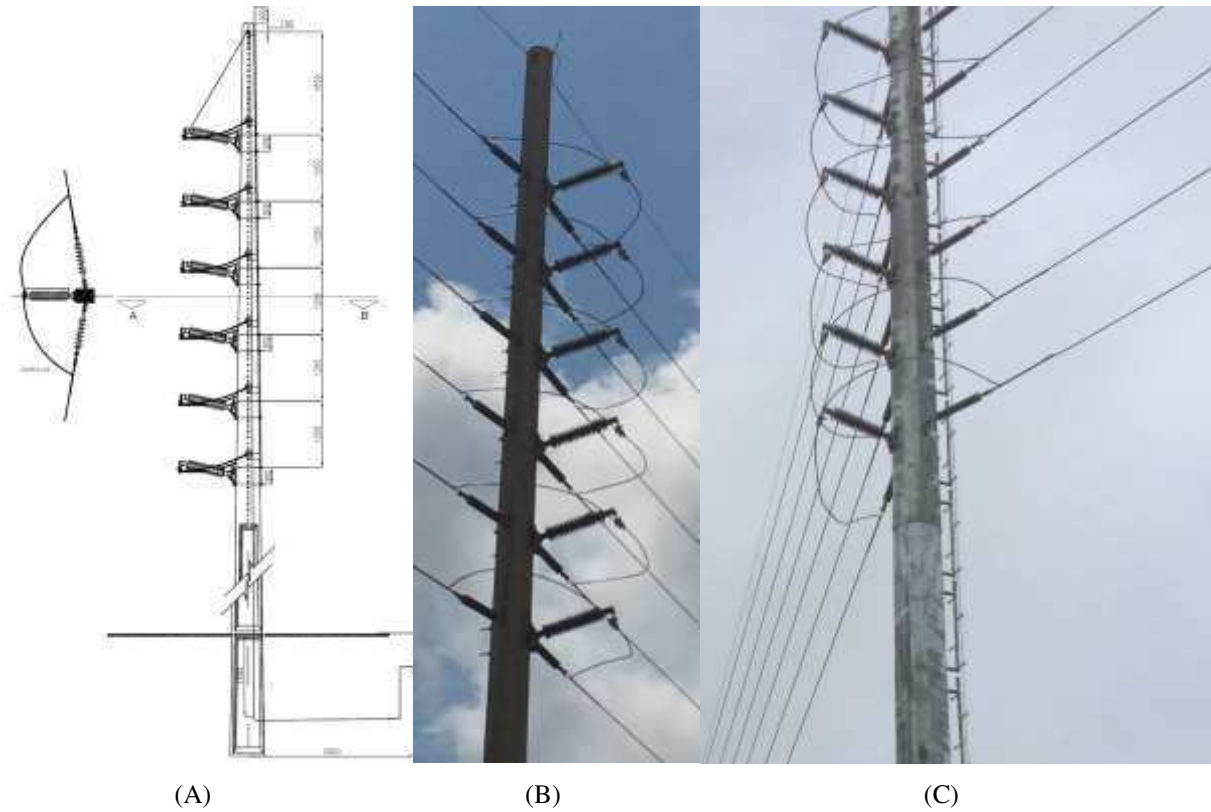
Estrutura 2Y-AG: (A) especificações do projeto; (B) estrutura em alinhamento reto finalizada (poste de concreto); (C) estrutura em ângulo obtuso finalizada (poste metálico).
